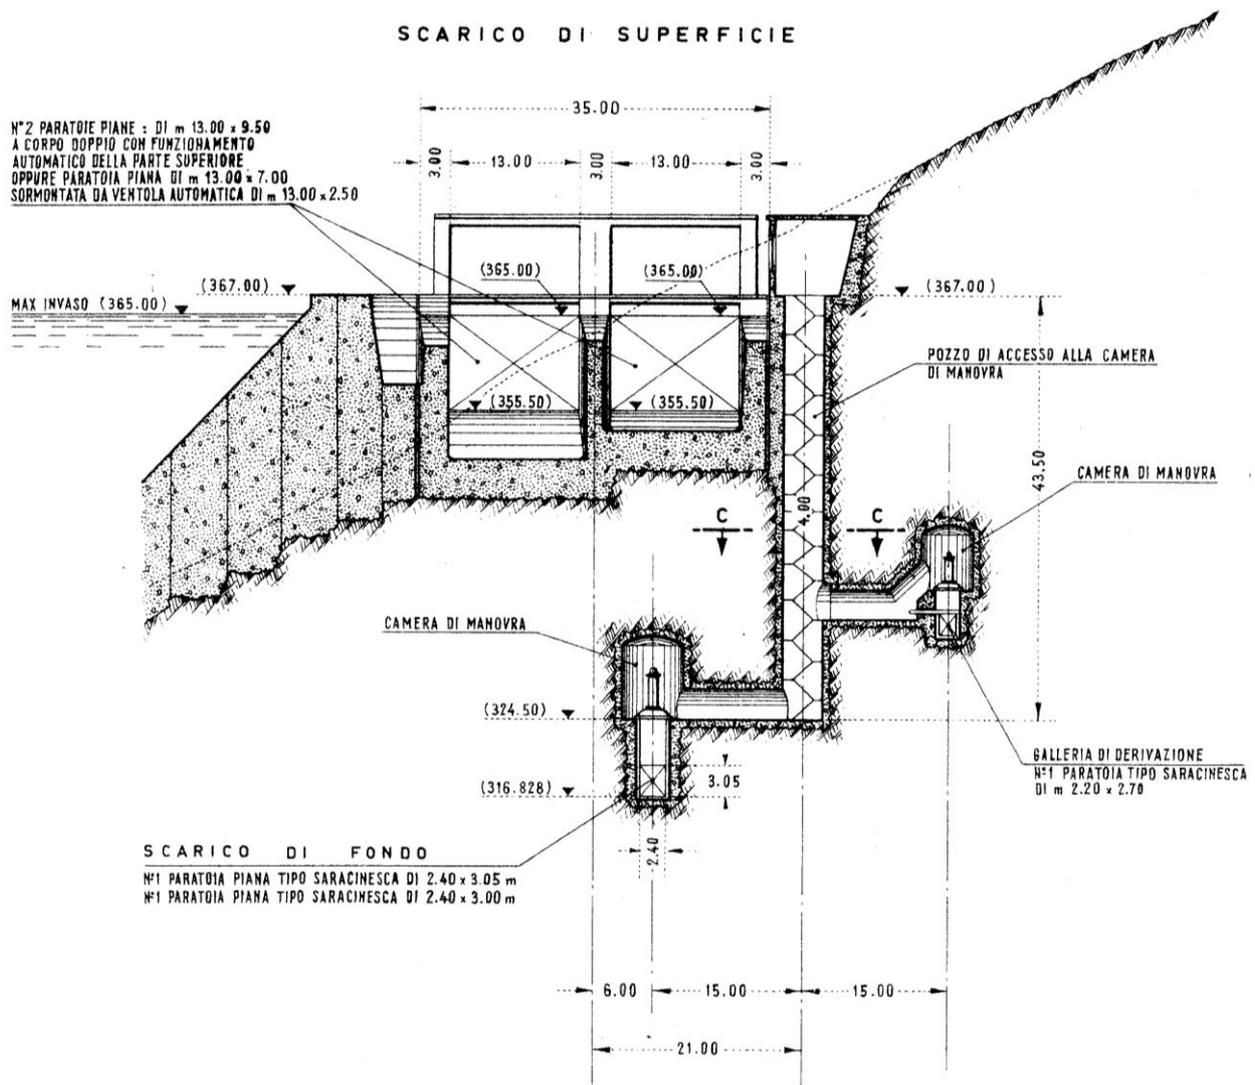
Prospetto dello scarico di superficie dal progetto originale della diga
